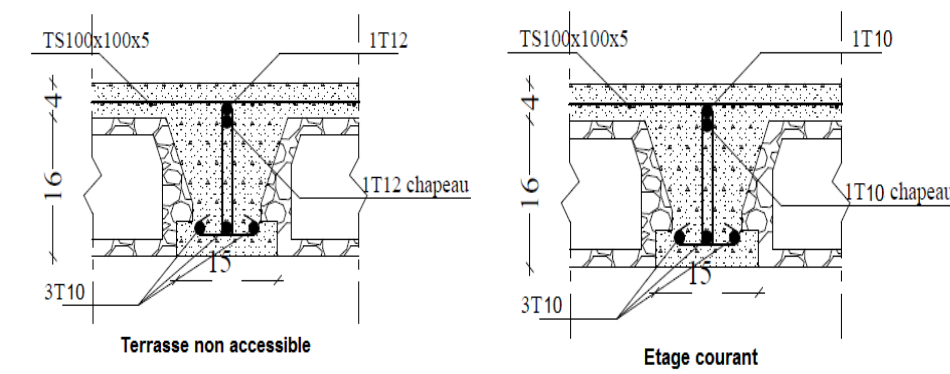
schéma de ferrailage des poutrelles de bloc C
